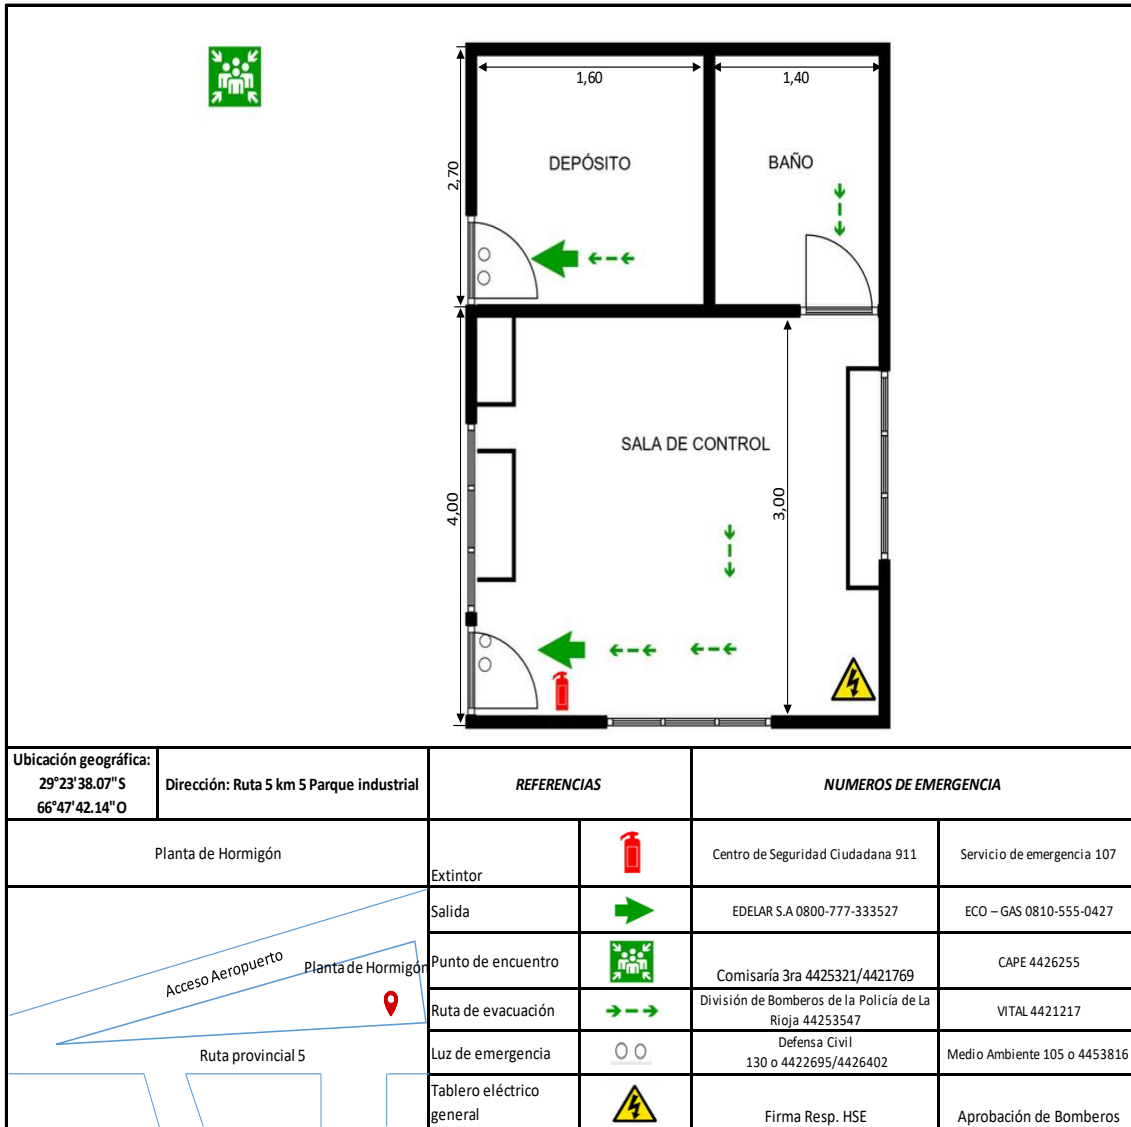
Plano de evacuación planta de hormigón Maggiora S.A, 2023
